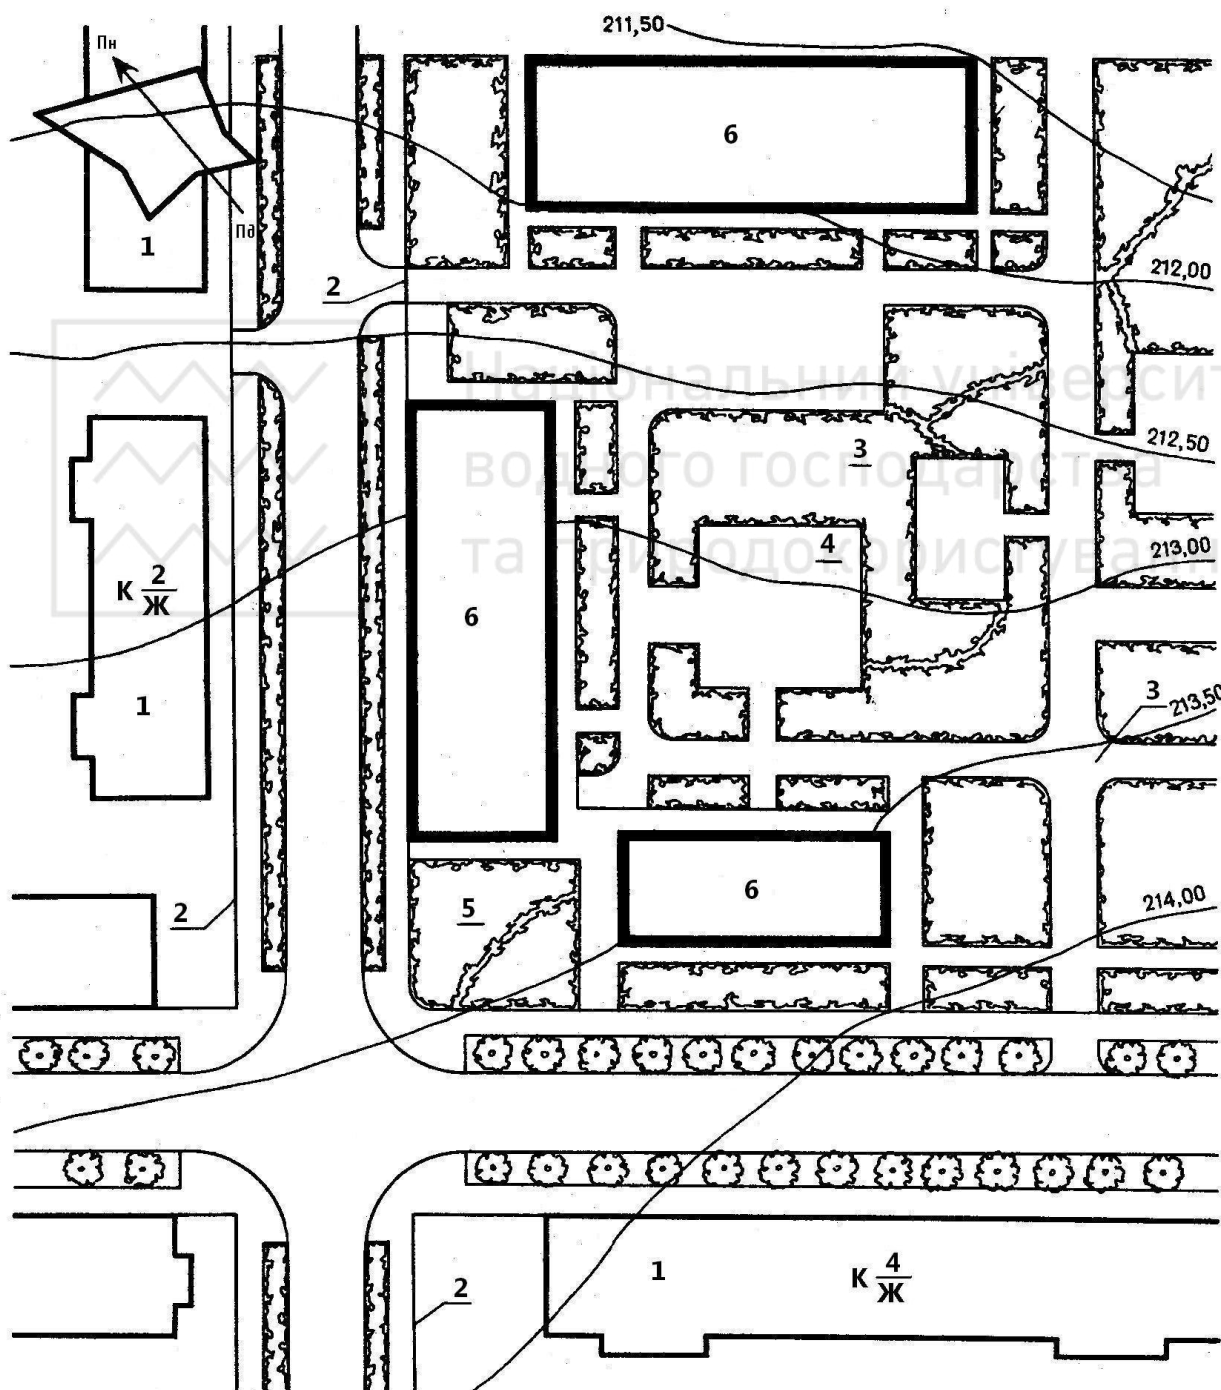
Частина генерального плану забудови житлового кварталу
